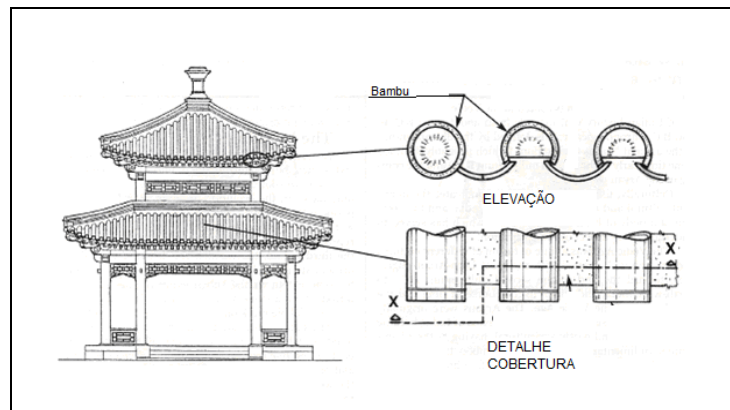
Telhas de bambu das construções tradicionais chinesas
